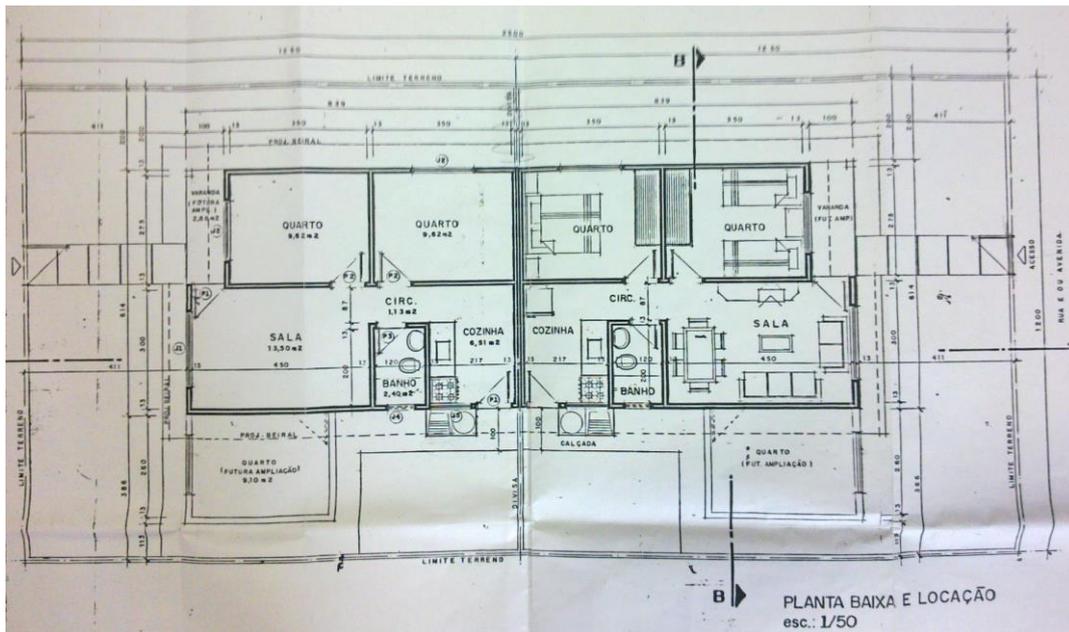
Imagem do projeto da planta baixa da unidade geminada.
